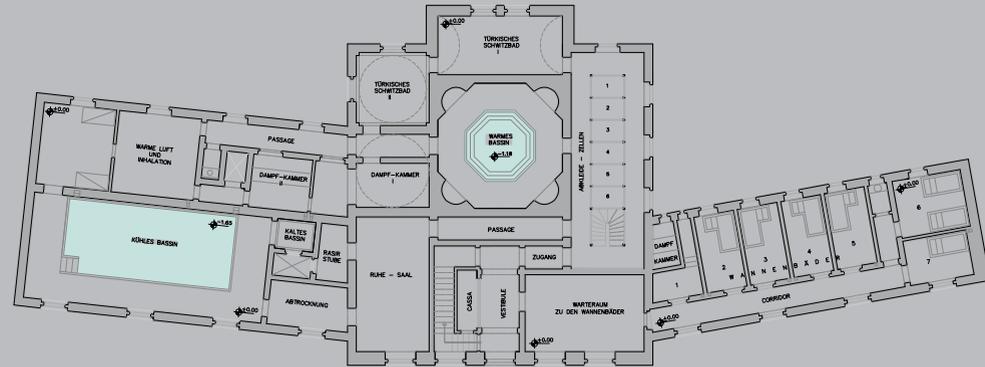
Alter Grundriss\_Erdgeschoss (aus 1890)
